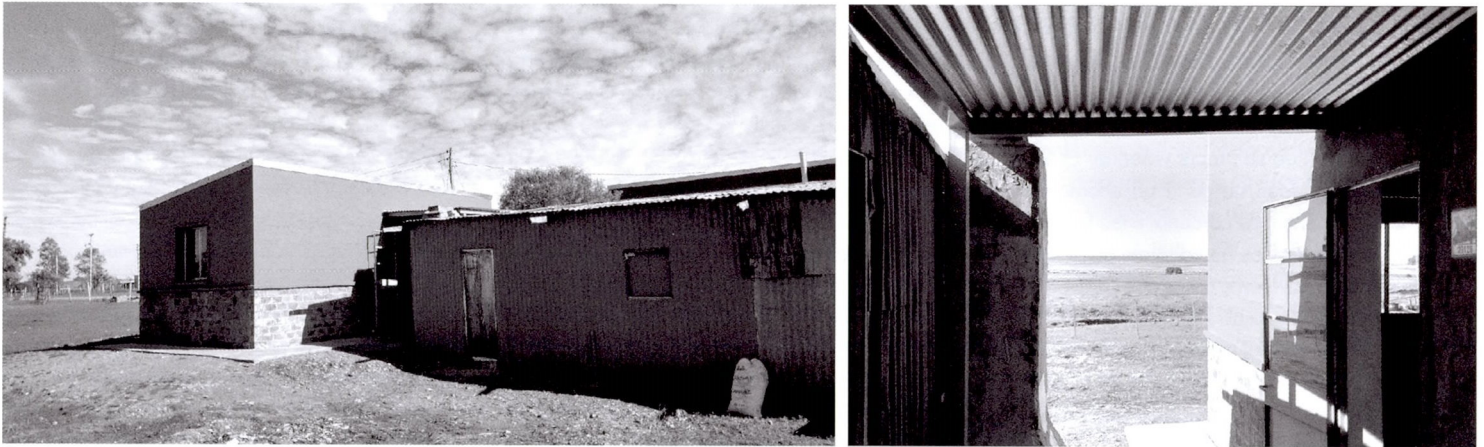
Sequeira. Vista parcial de viviendas y de la unión de construcción nueva y existente
